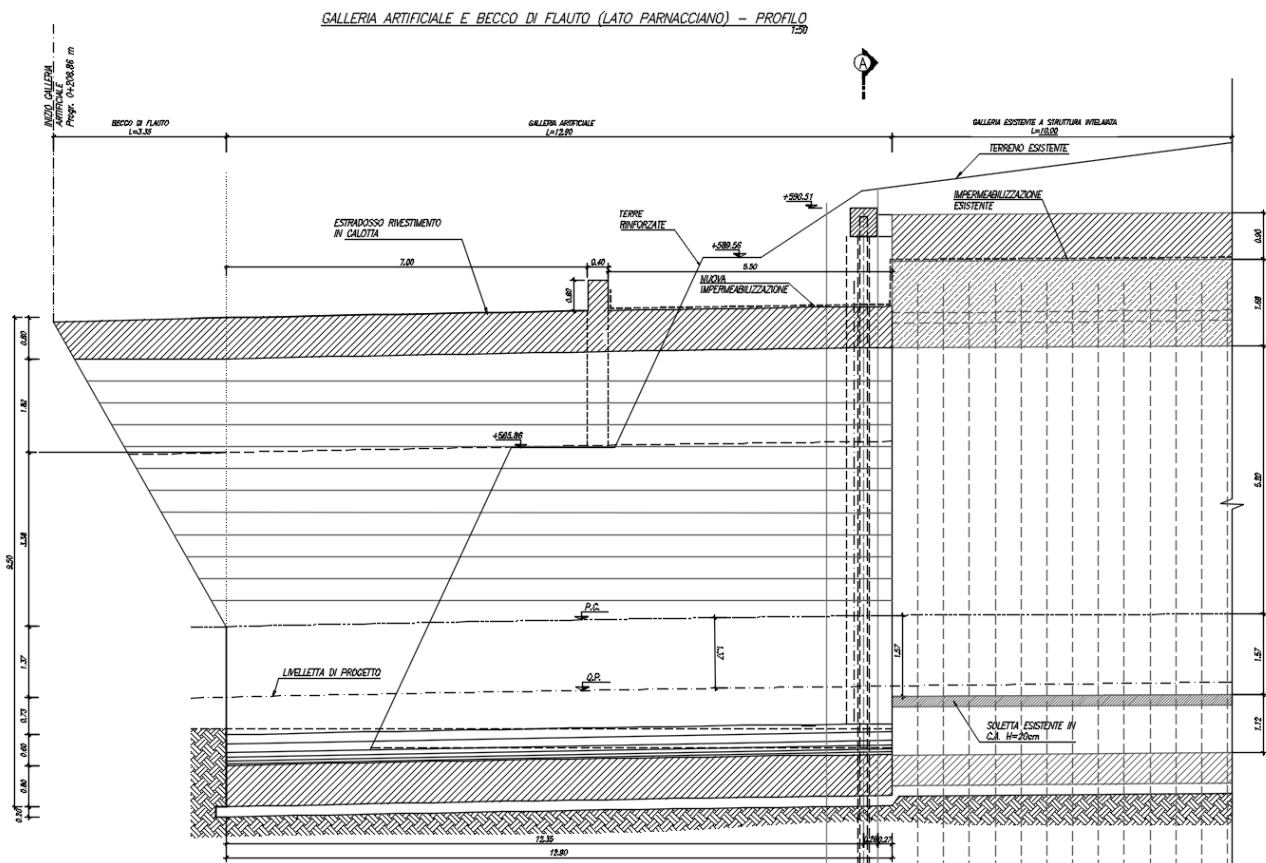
Profilo imbocco lato Umbria con individuazione sezione di verifica (sez. A)
